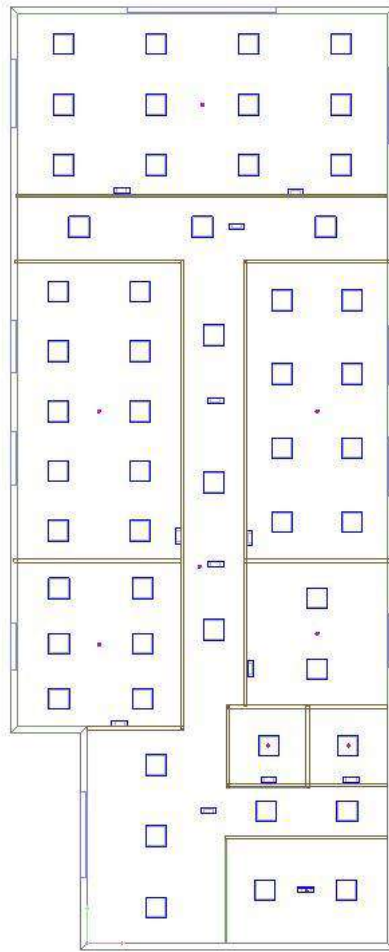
Ubicación de las luminarias en la planta baja.
